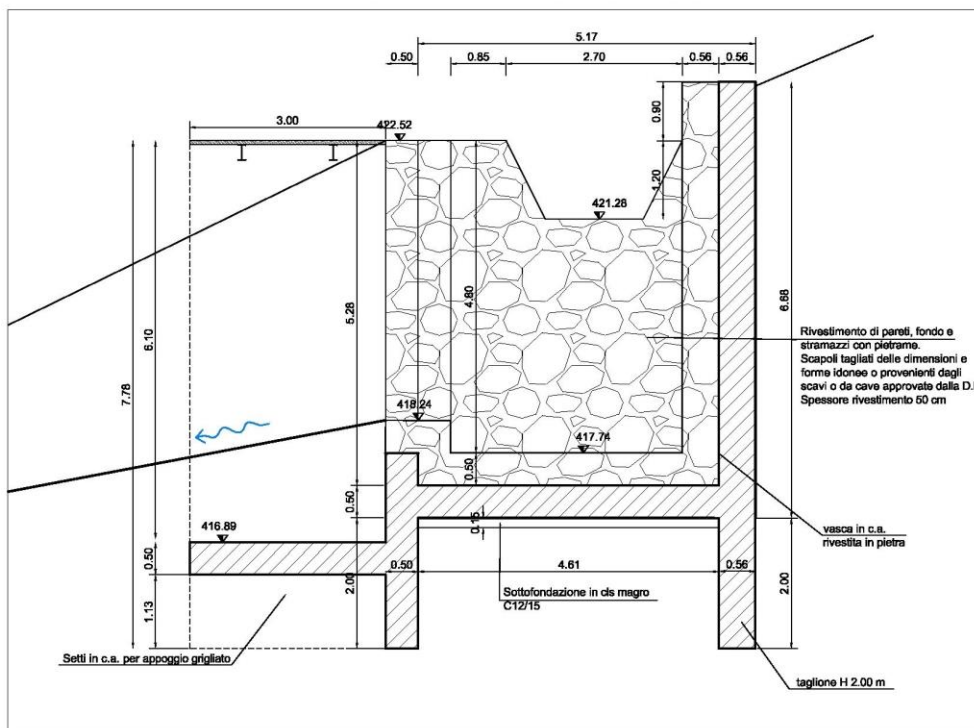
Compluvio centrale – Vasca Vi7 - sezione
